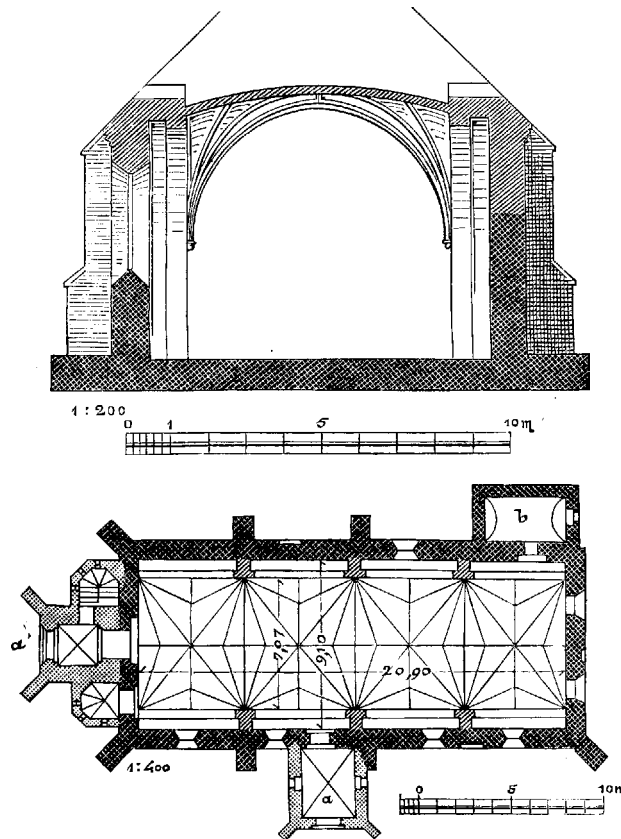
u. 35. Tiefenau. Querschnitt und Grundriss der Kirche.
